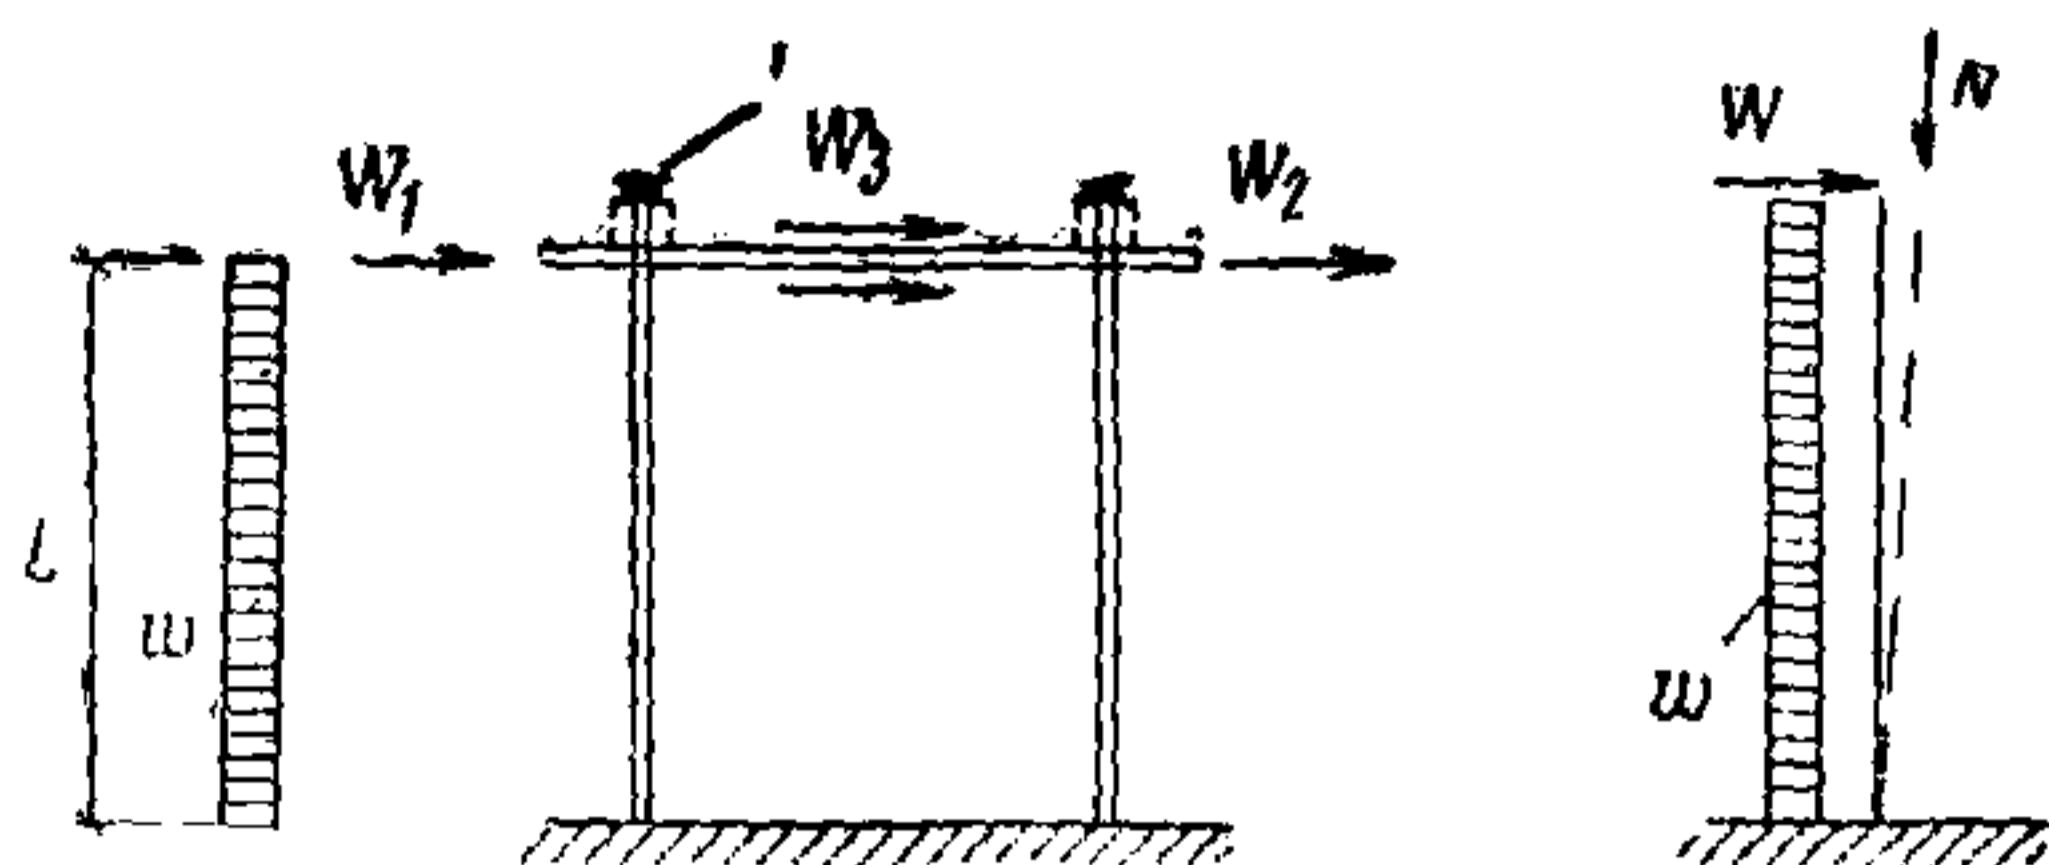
Схема расчетных ветровых нагрузок на поперечную раму
